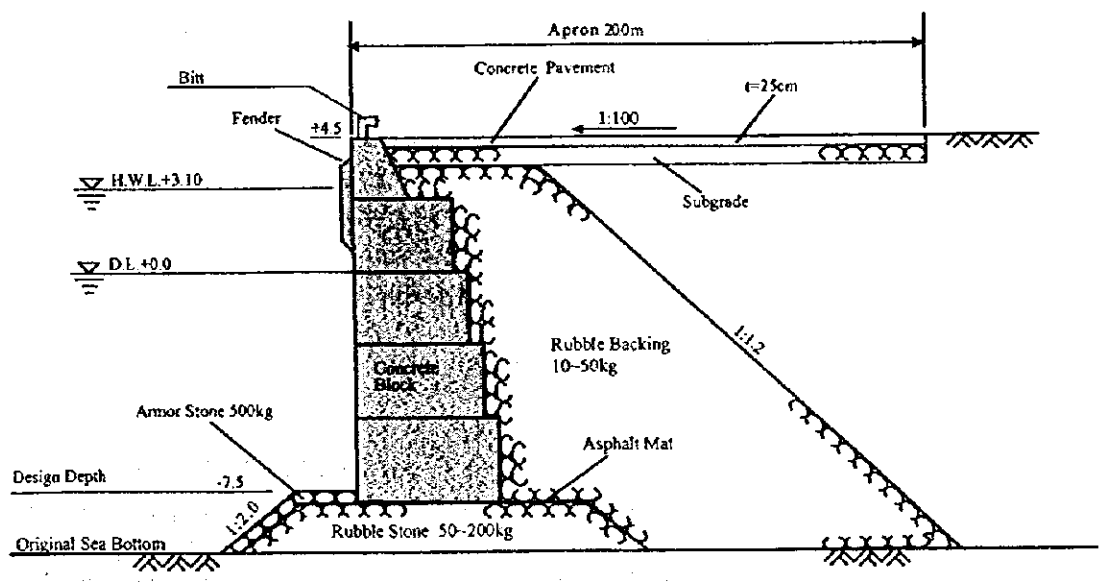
Atracadero de Pasajeros del Tipo Bloque de Hormigón (-7.5m)
